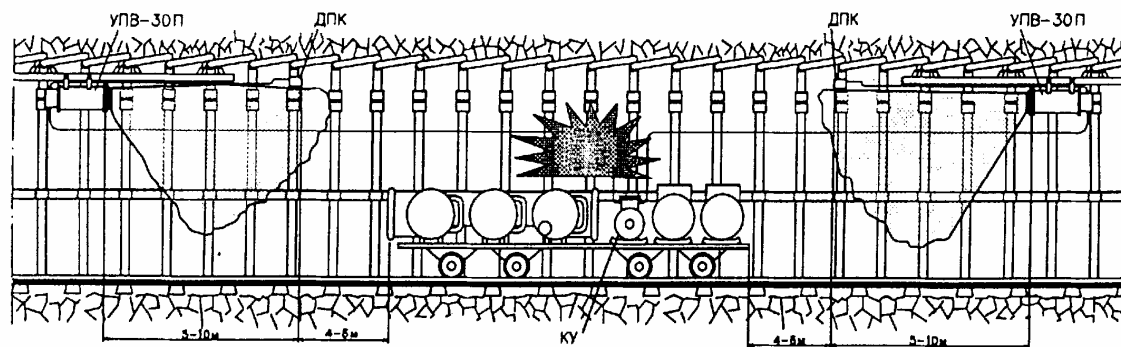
Schema montării sistemului SLVA.O pentru protecția unei stații de schimb / Layout diagram of components of the SLVA.O system protecting an electrical switchgear station in underground mine
